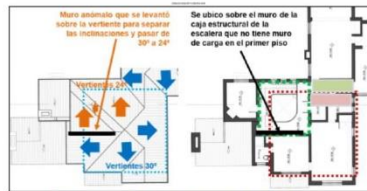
Detalle de torpes ajustes constructivos en la cubierta.
